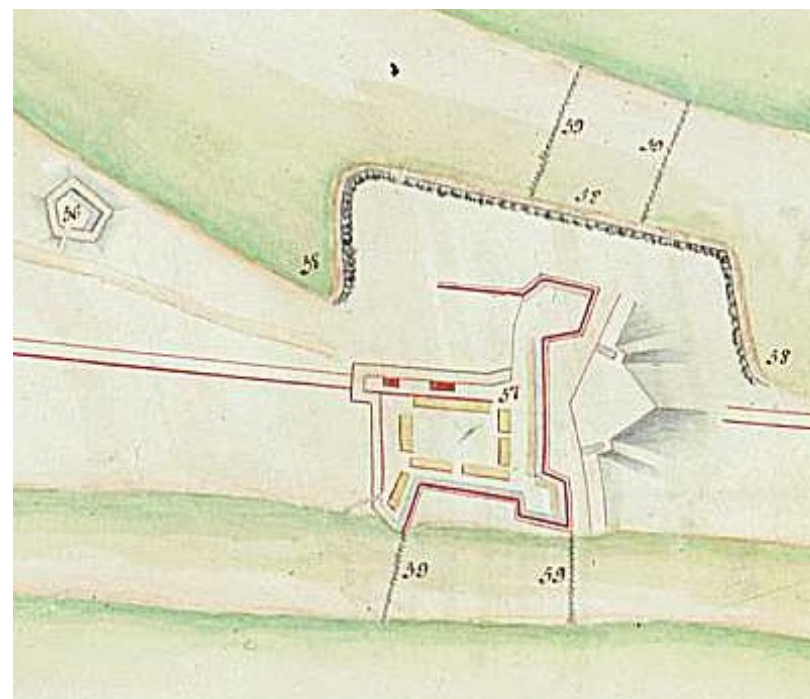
plano de 1812 de la fortificación de la Cortadura.
